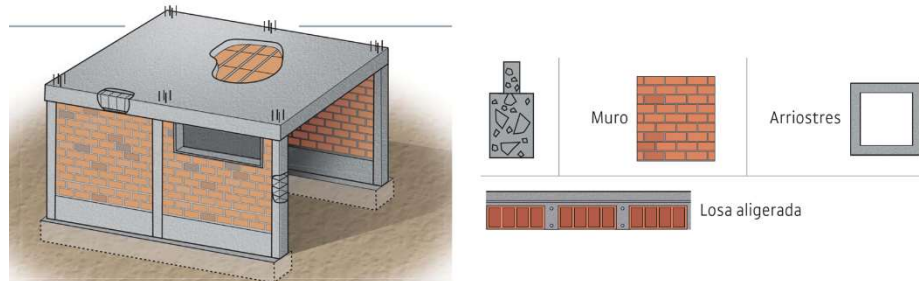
elementos estruturais da casa “vernacula moderna”. Fonte: Aceros Arequipa
